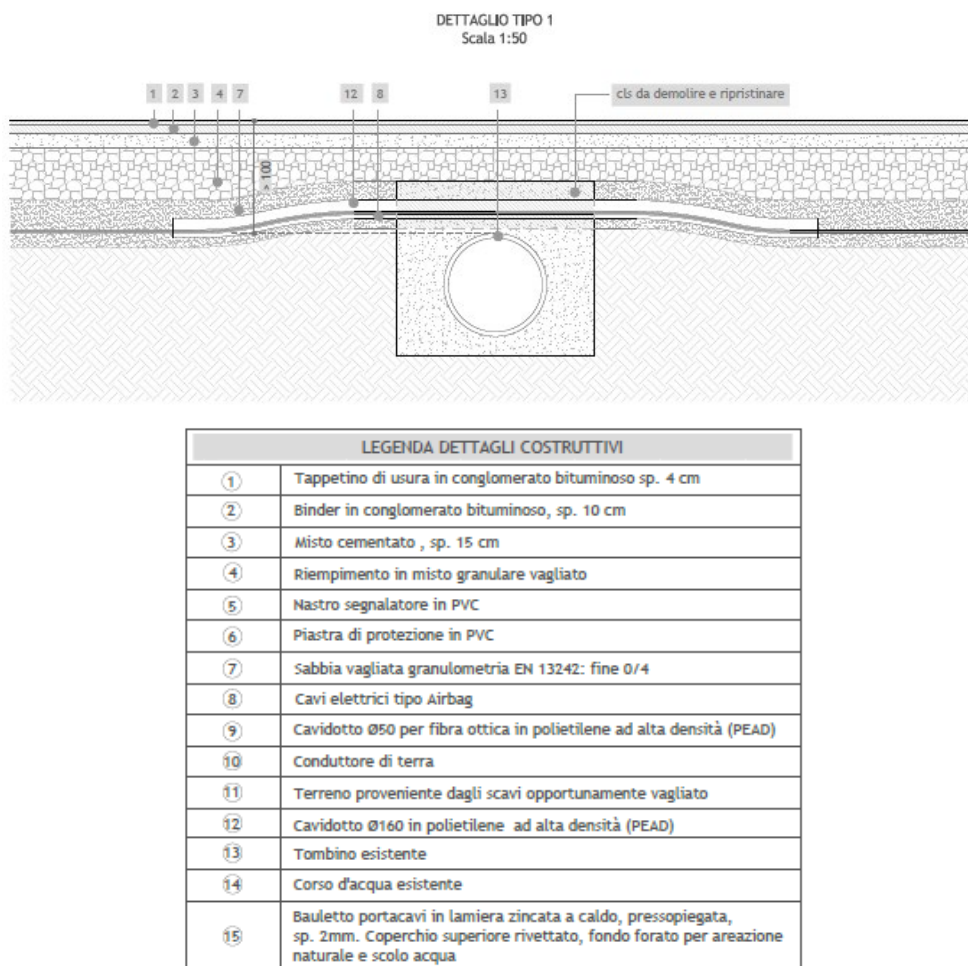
Attraversamento tipo 1 – Attraversamento della viabilità esistente
